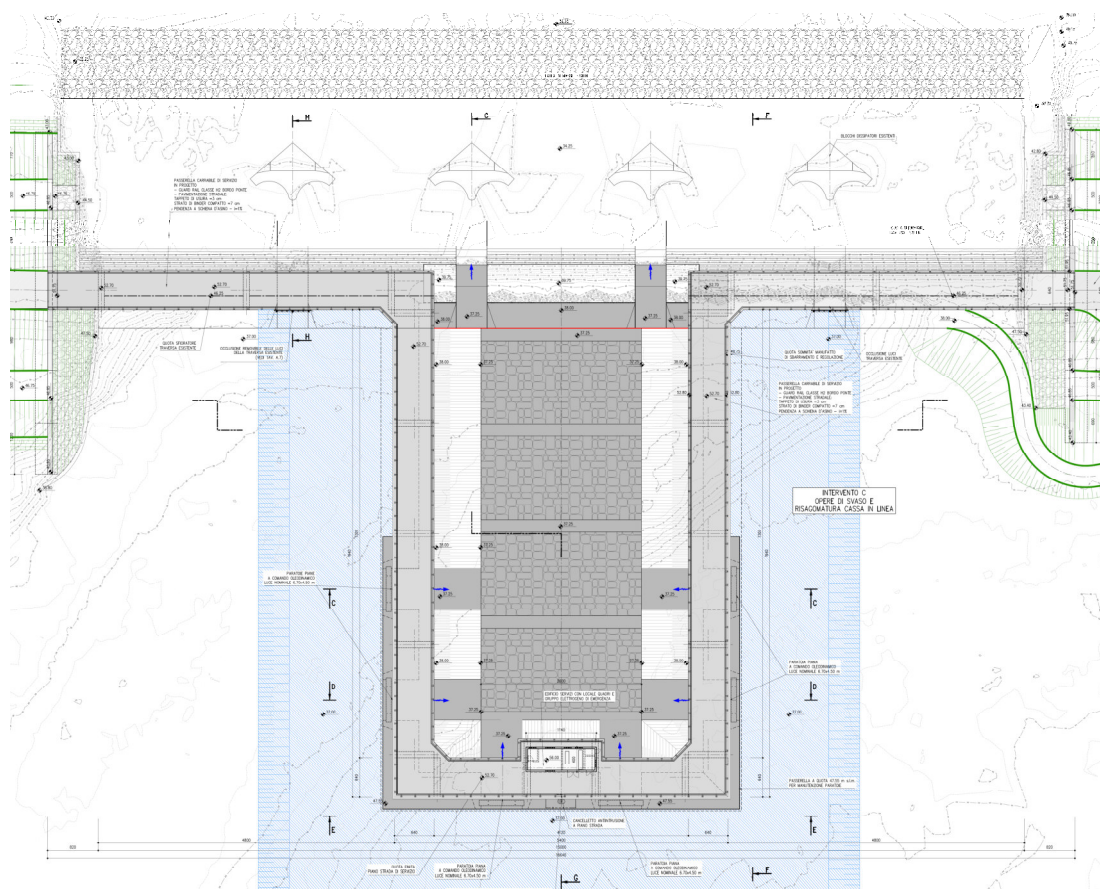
Adeguamento manufatto di regolazione in linea - Pianta
